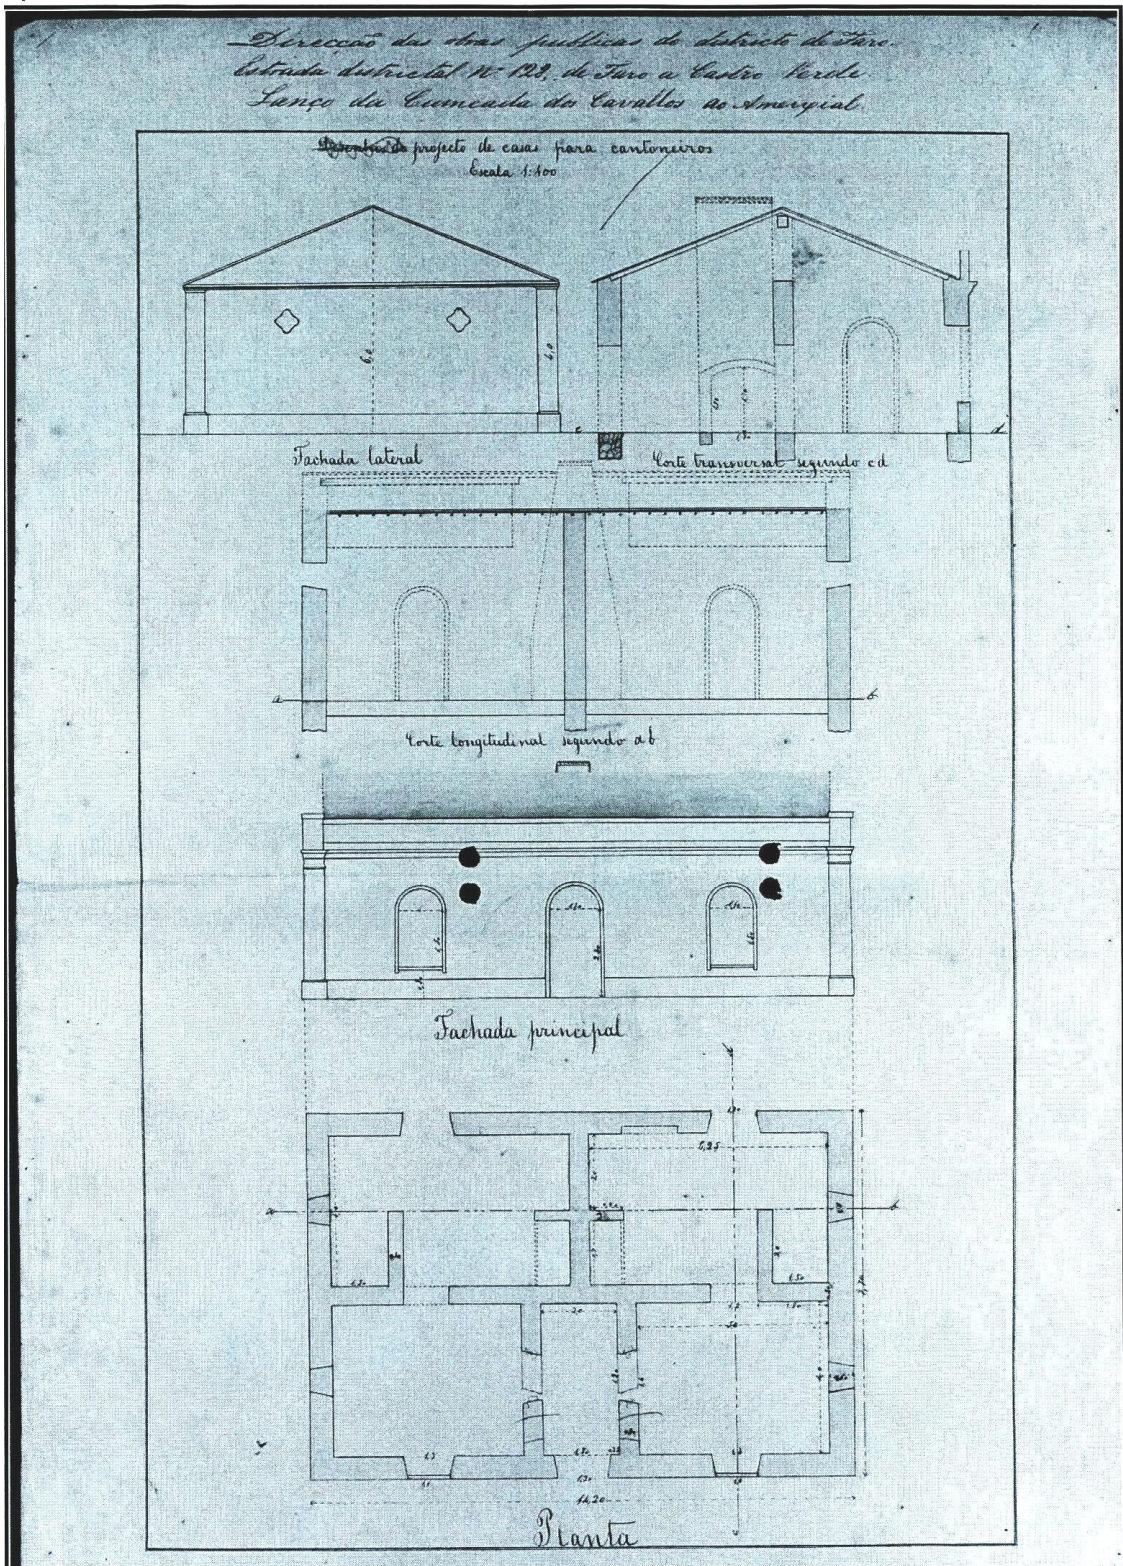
Planta, fachada e cortes d'uma casa para cantoneiros. (1)
